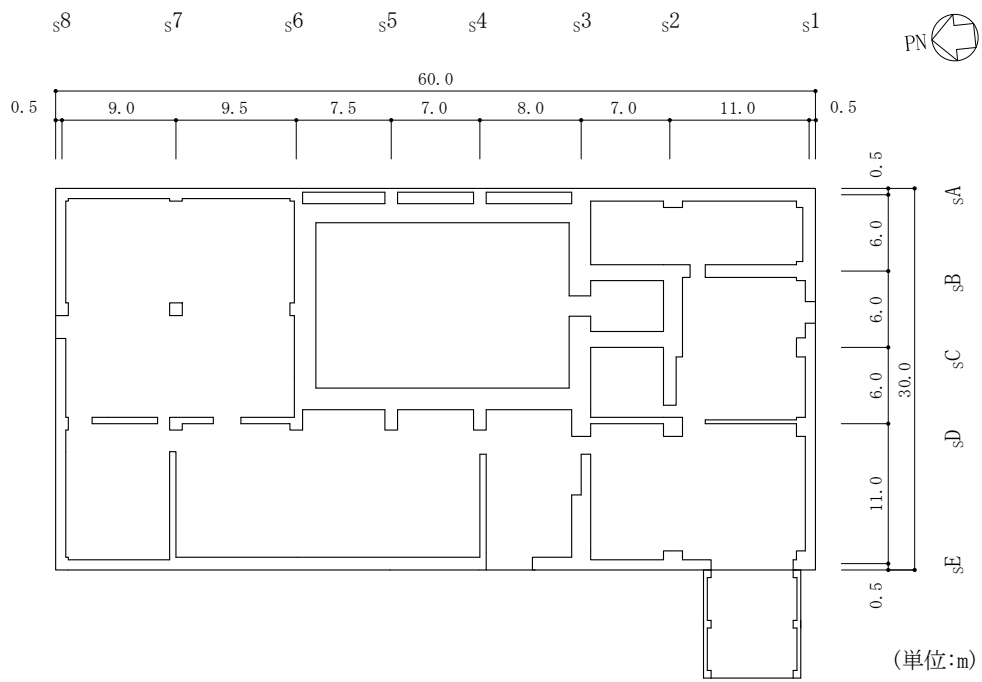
サイトバンカ建物の概略平面図 (EL 8.8m*)
